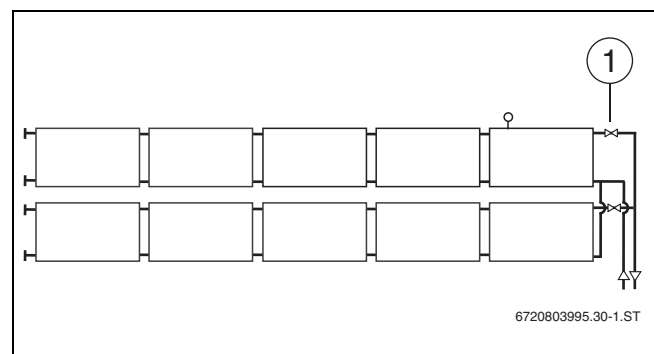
Gleichseitiger Anschluss einer Parallelschaltung
